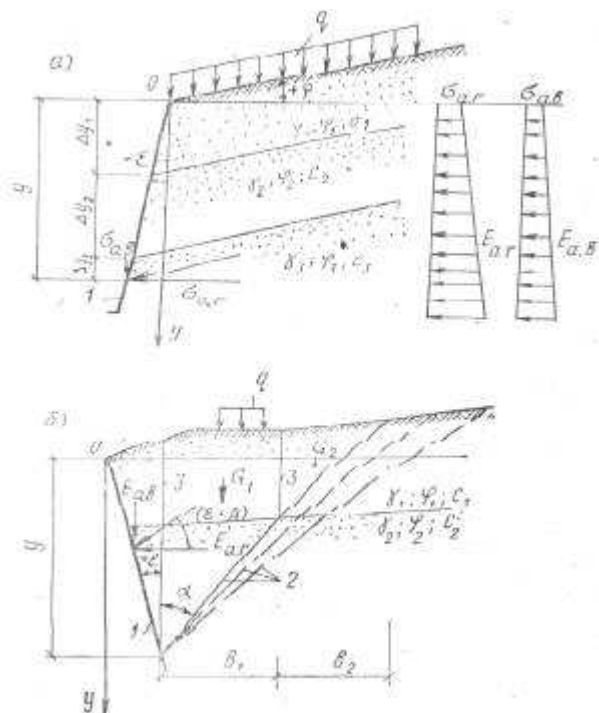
Схемы к расчету активного давления грунта: а – аналитическим, б – графическим способом
